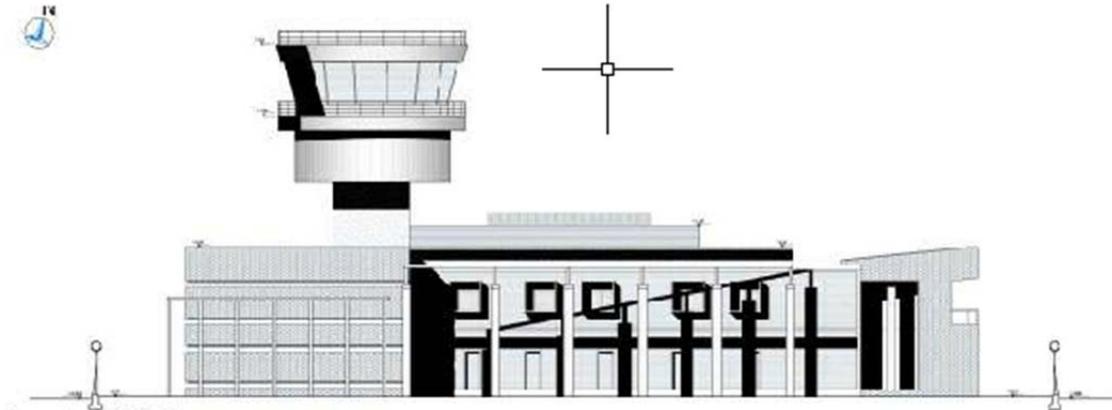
Schema planimetrico della nuova torre di controllo.
